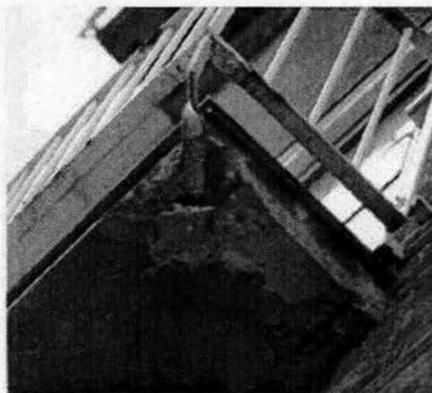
Corrosión del acero de refuerzo y deterioro del concreto en la zona en que se fijó la baranda de protección del balcón. Causa del problema: Metales diferentes en contacto (baranda y acero de refuerzo de la estructura) y penetración de cloruros.
